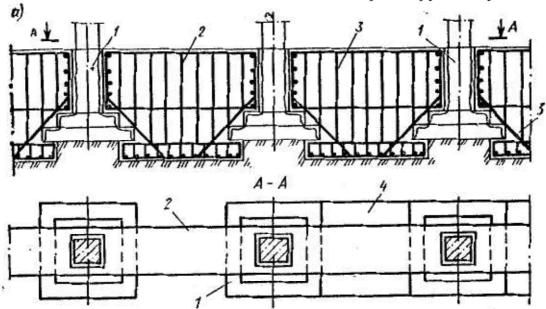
Схема переустройства столбчатых фундаментов в ленточные 1 - столбчатый фундамент; 2 - железобетонная перемычка; 3 - арматурные каркасы; 4 - уширенная часть железобетонной перемычки.
